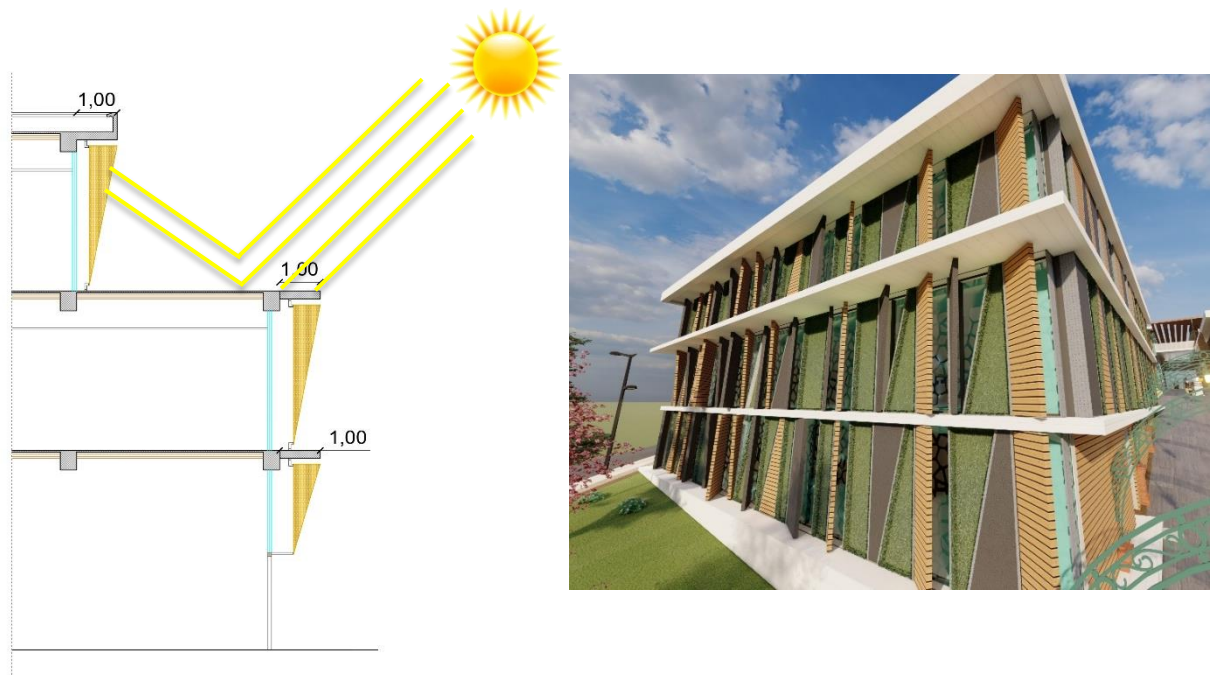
Brise soleil horizontale et verticale sur la façade sud du projet.
